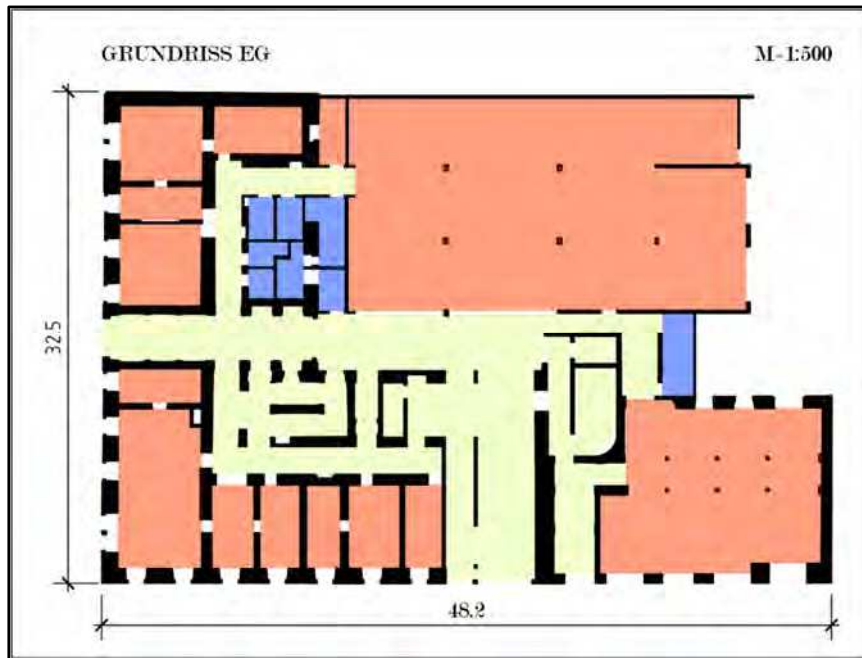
Illustration L: Grundriss Erdgeschoss Bezirkshauptmannschaft
